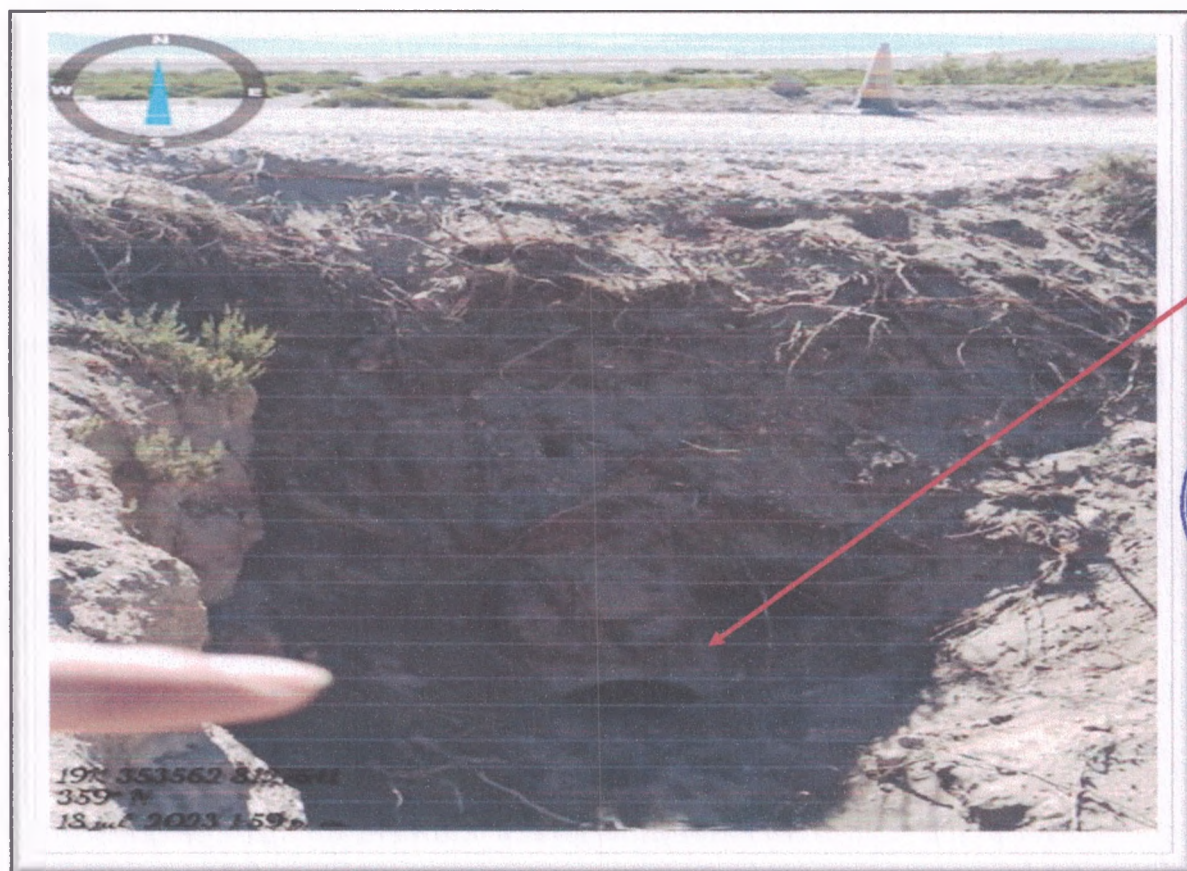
Vista de Alcantarilla saturada de piedras, arena, tierra y basuras.
